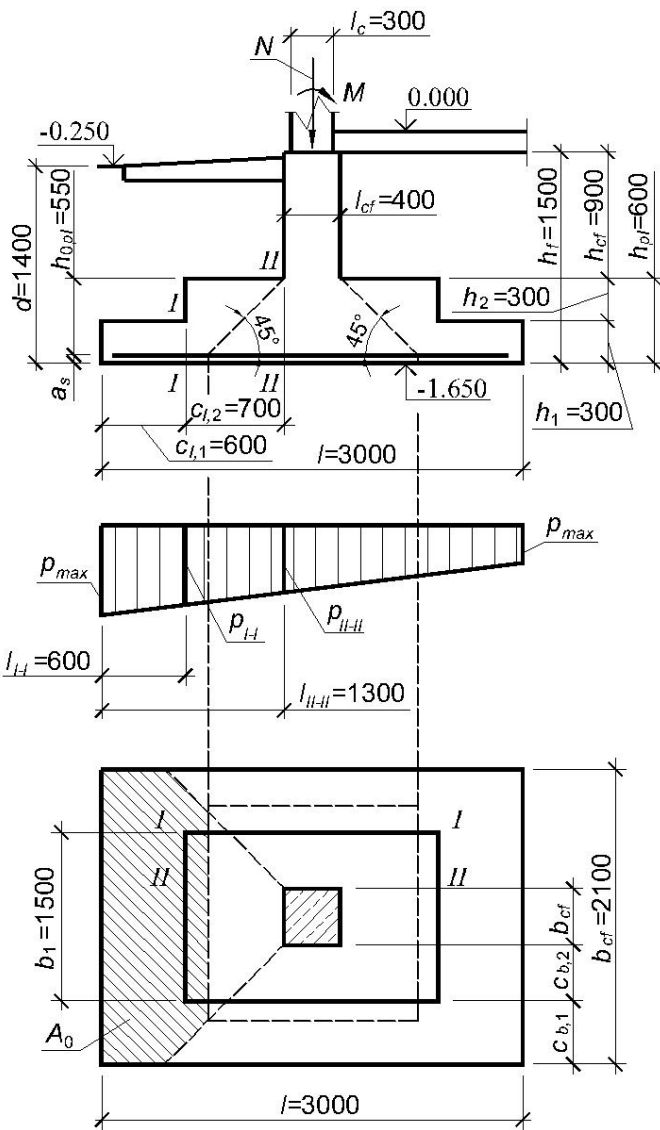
Расчетная схема к конструированию отдельного фундамента под колонну и для расчета прочности его плитной части на продавливание (пример 4.9)
